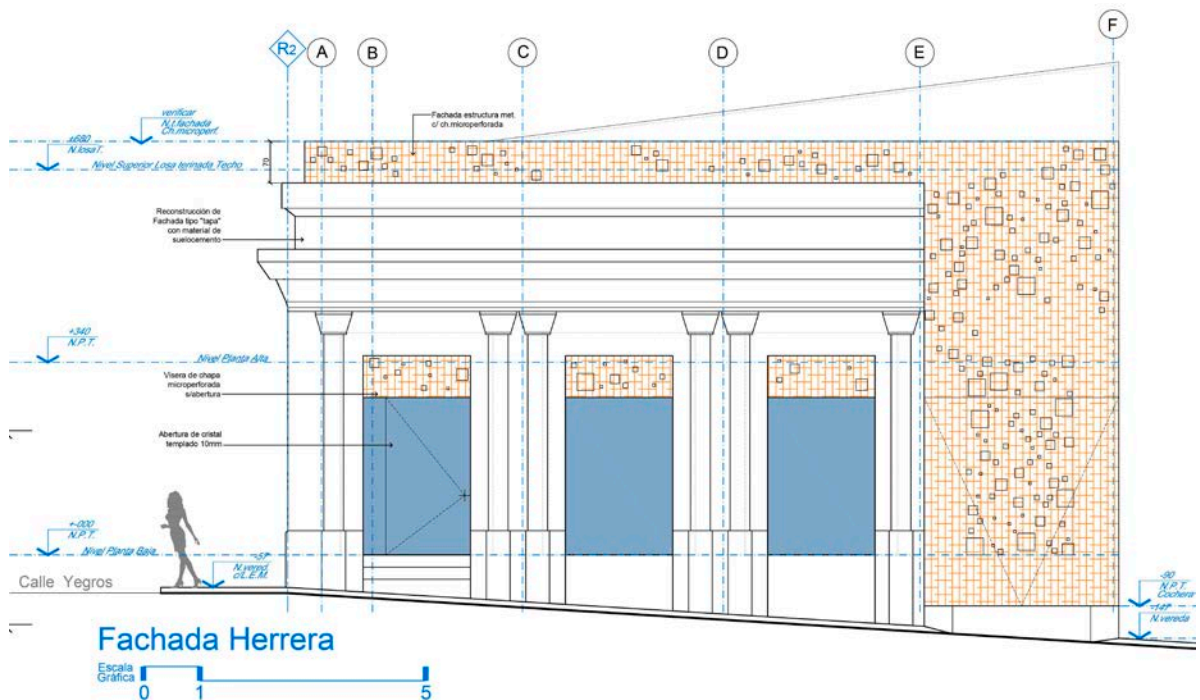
La fachada reconstruida con suelo cemento sobre la Calle Herrera. La caja de la nueva arquitectura detrás
